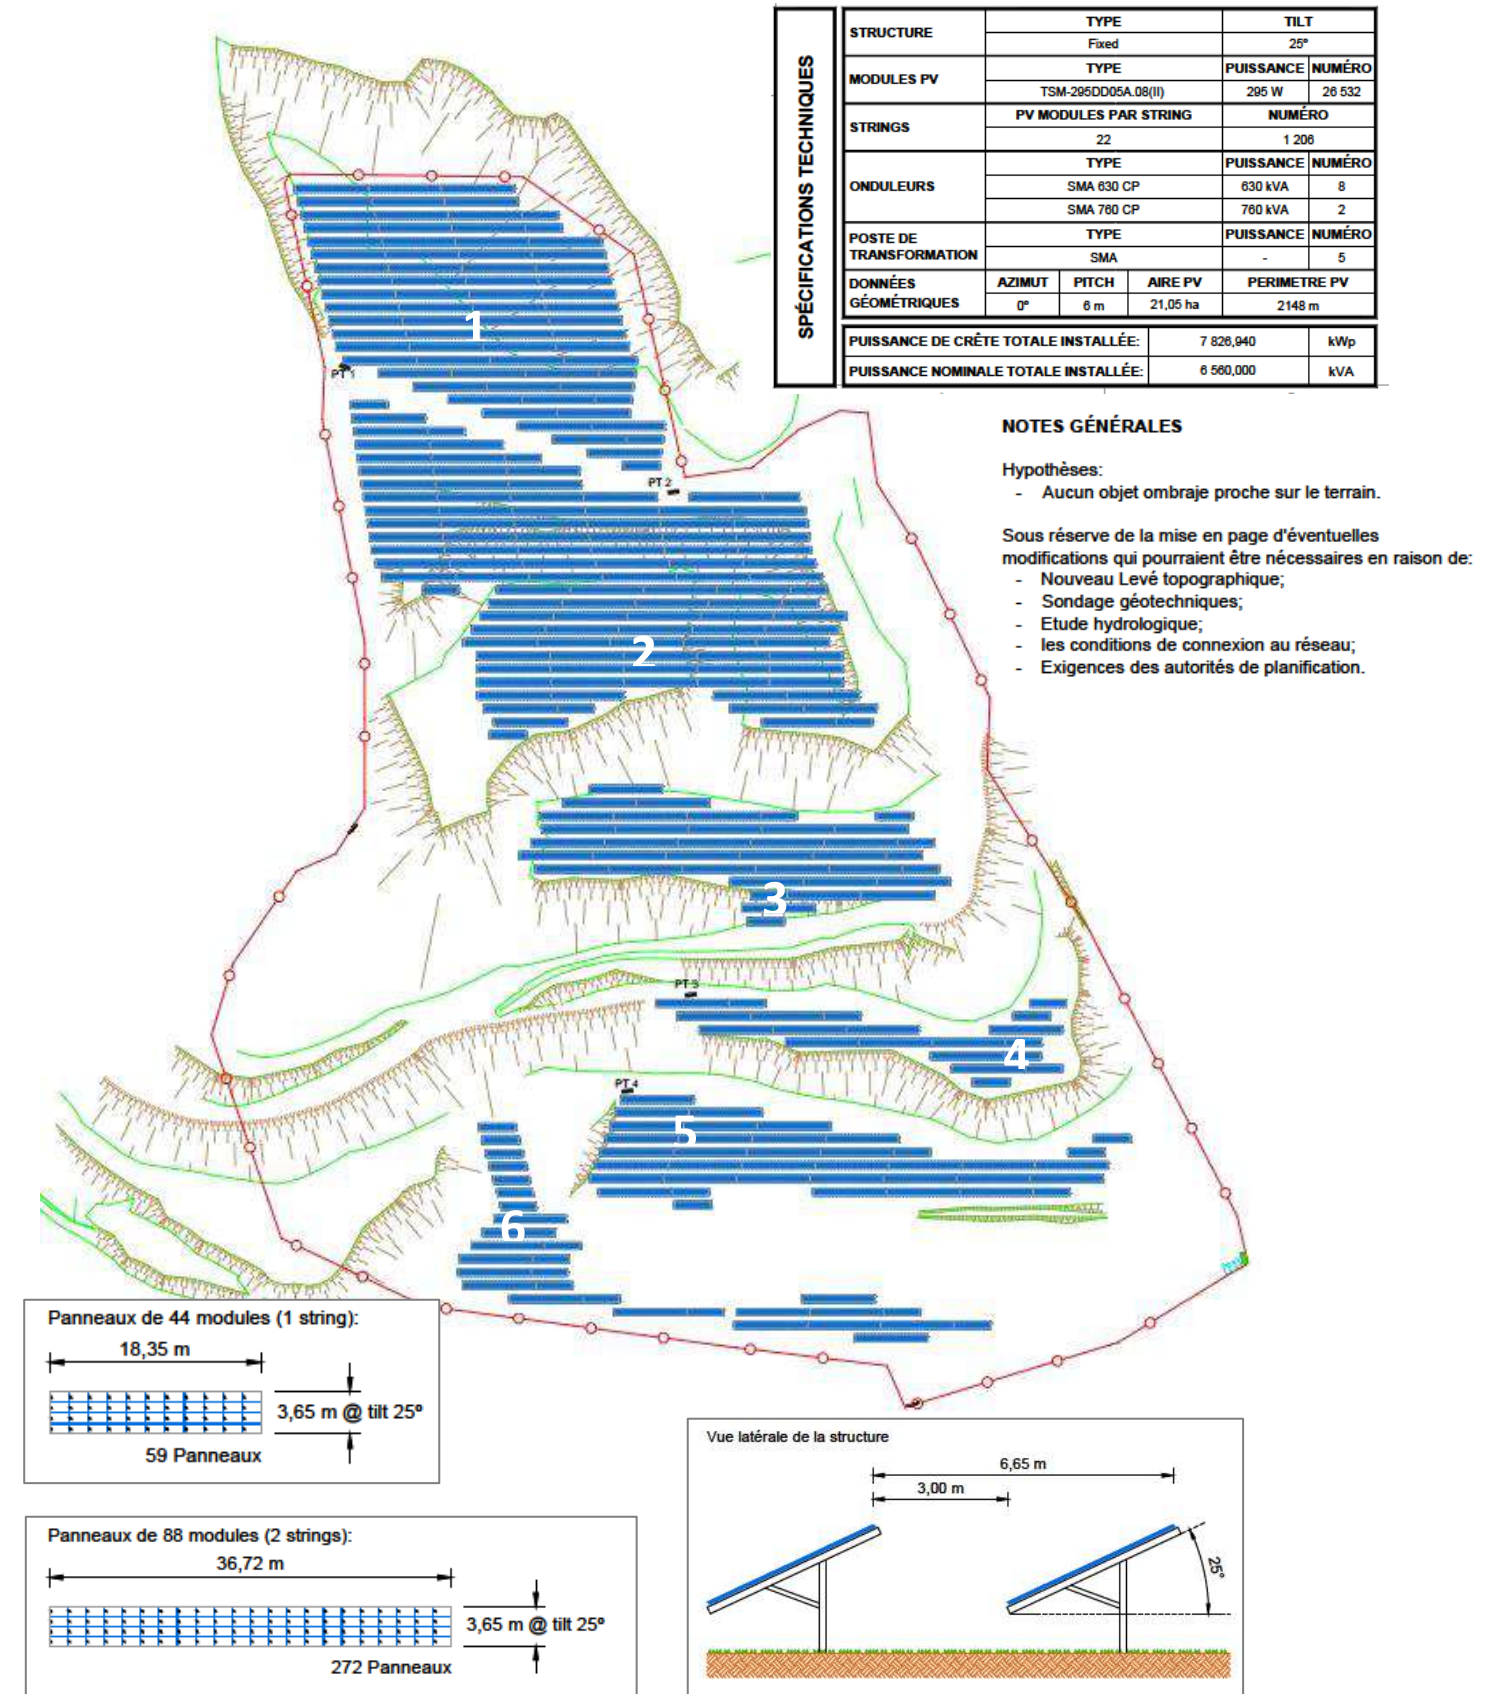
Plan d'implantation (d'après ENGINEERING, mars 2017)
